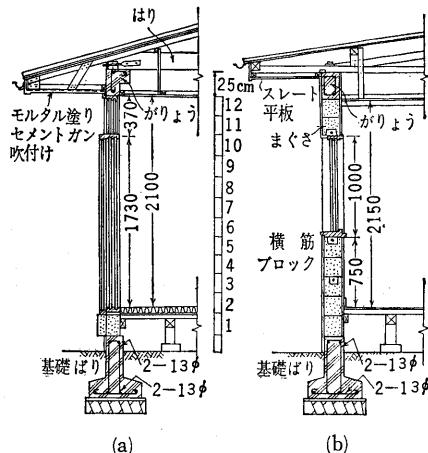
補強コンクリートブロック造建築物の構造(その1)
